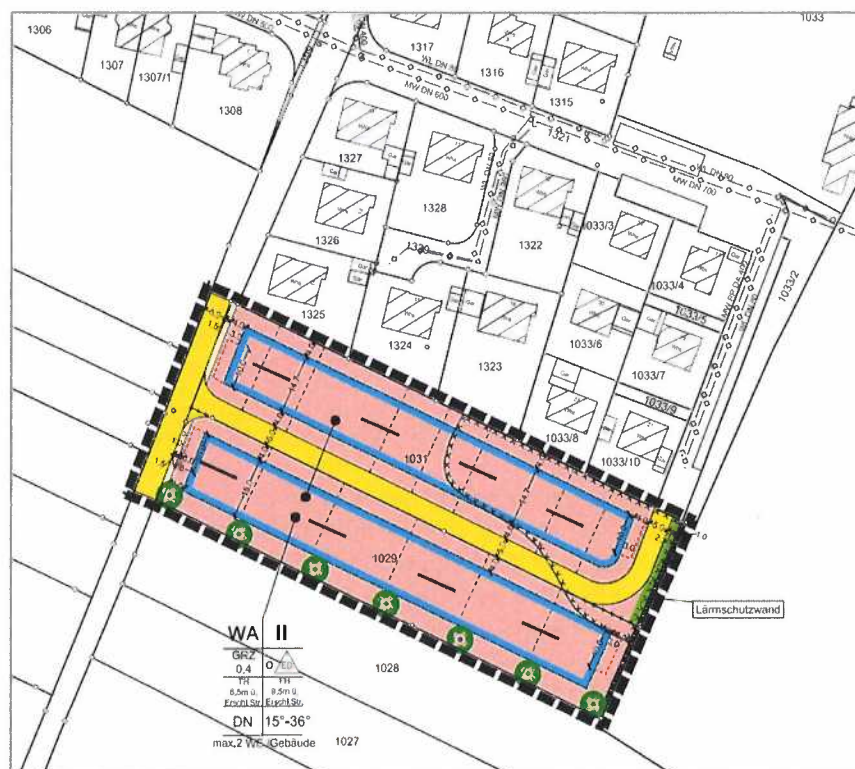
Bebauungsplan "Gern-Dellen IV"
